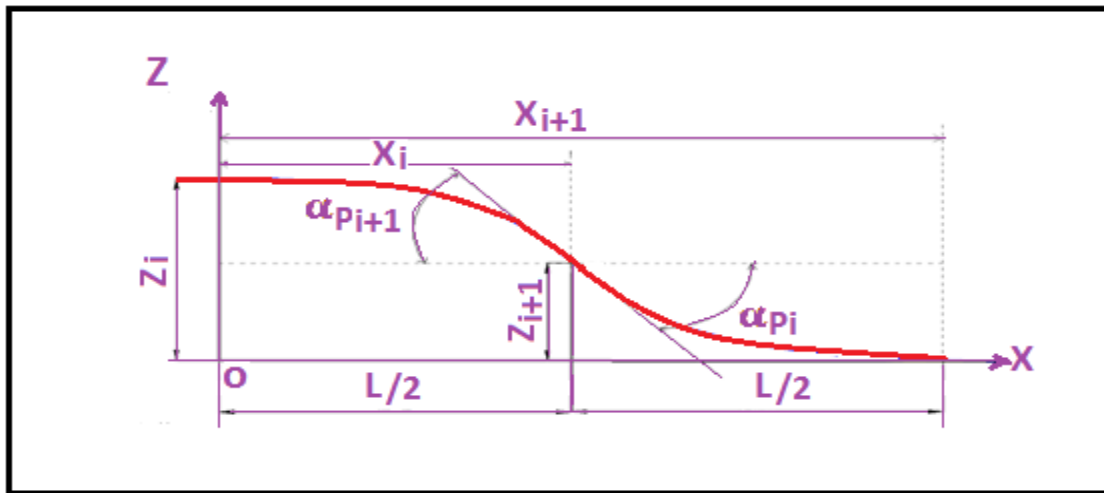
Tracé en plan d'un câble du fléau.
